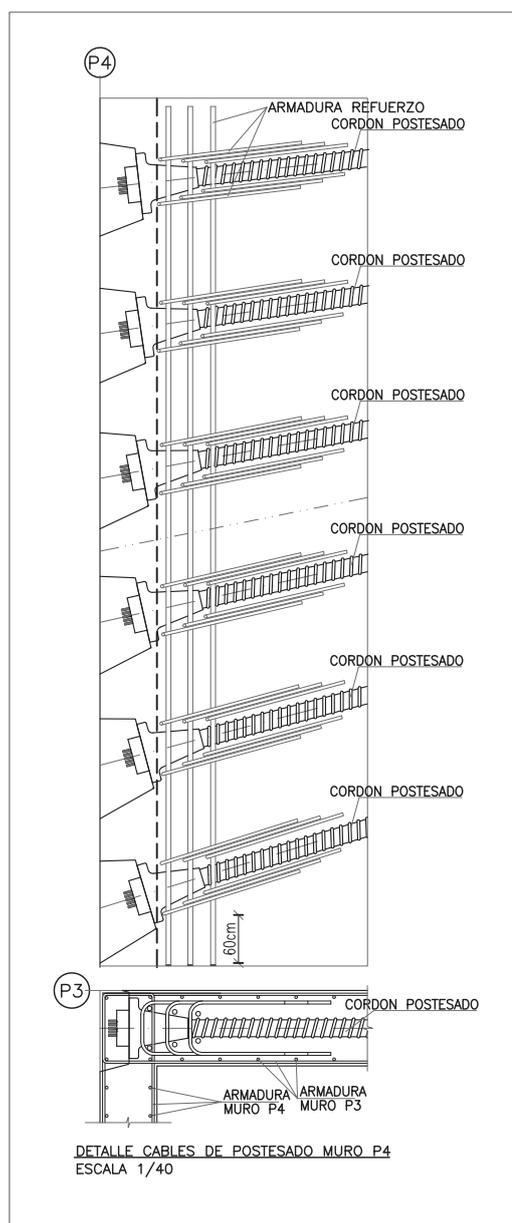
Detalle del arranque de los cables. Escala 1:40 [27] IMAGEN 3.12 Fotografía de obra del armado del muro, arranque. [29]
